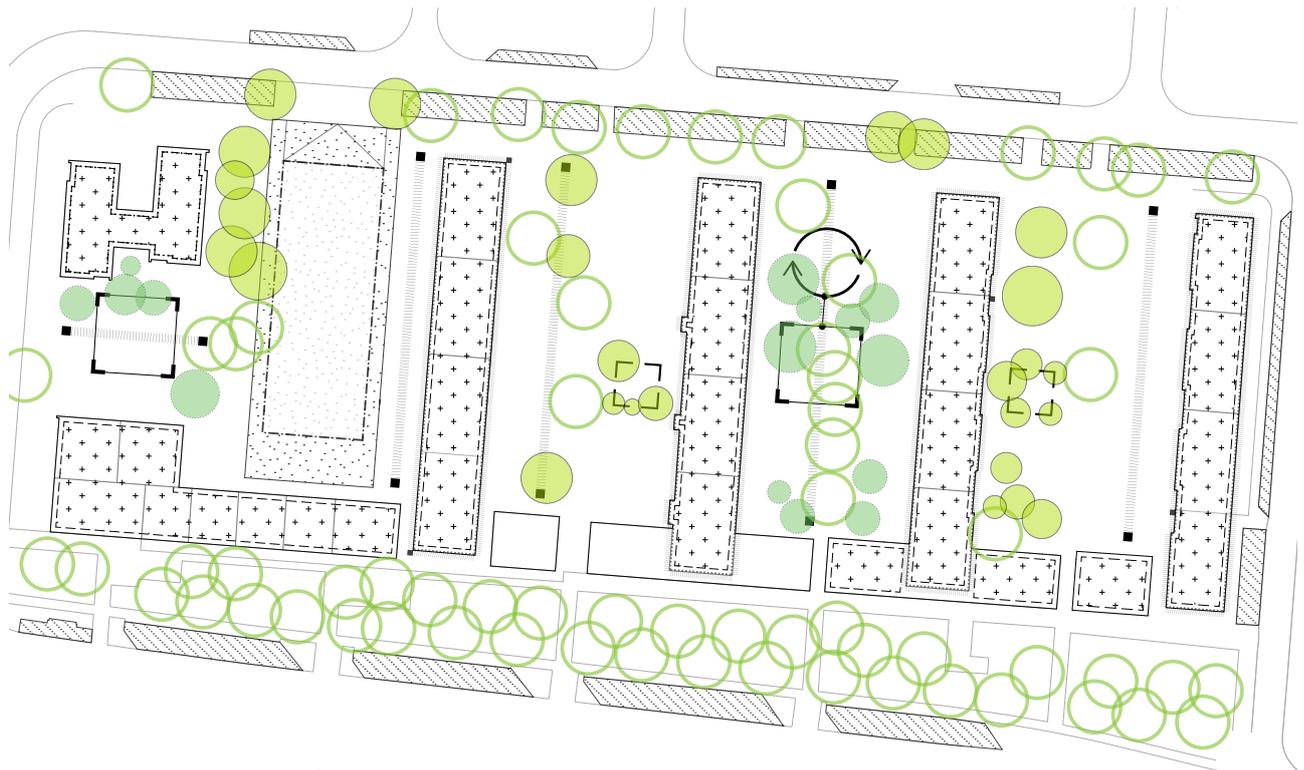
instanzspezifische Maßnahmenanwendung Stadtstrukturtyp 03 „Zeilenbebauung“
